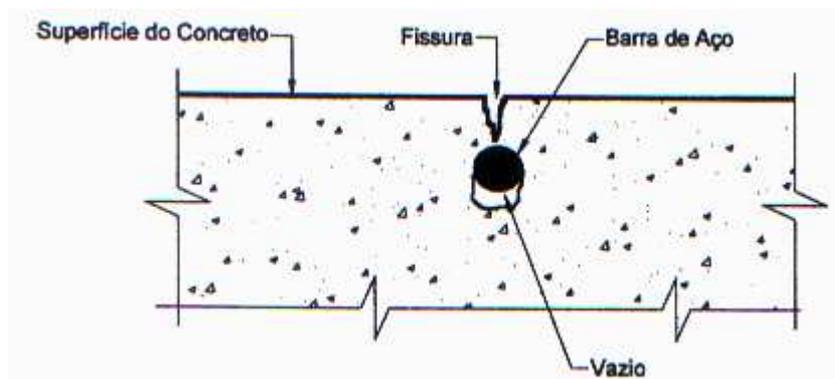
Configuração da fissuração por assentamento plástico
